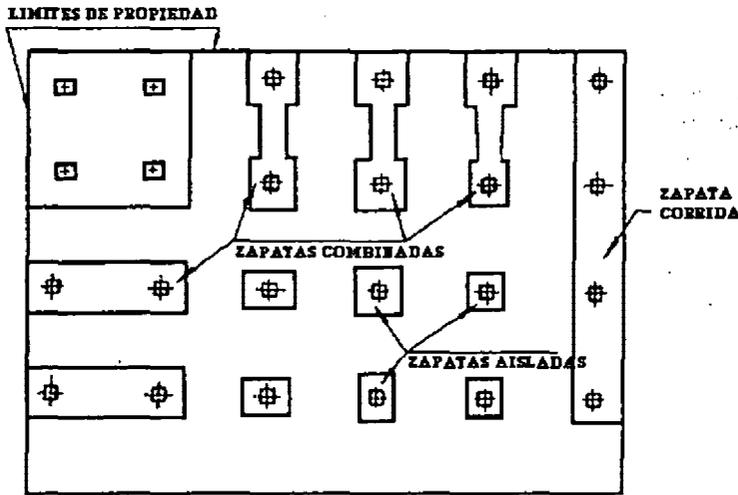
Esquema de utilización de cimentaciones superficiales.
